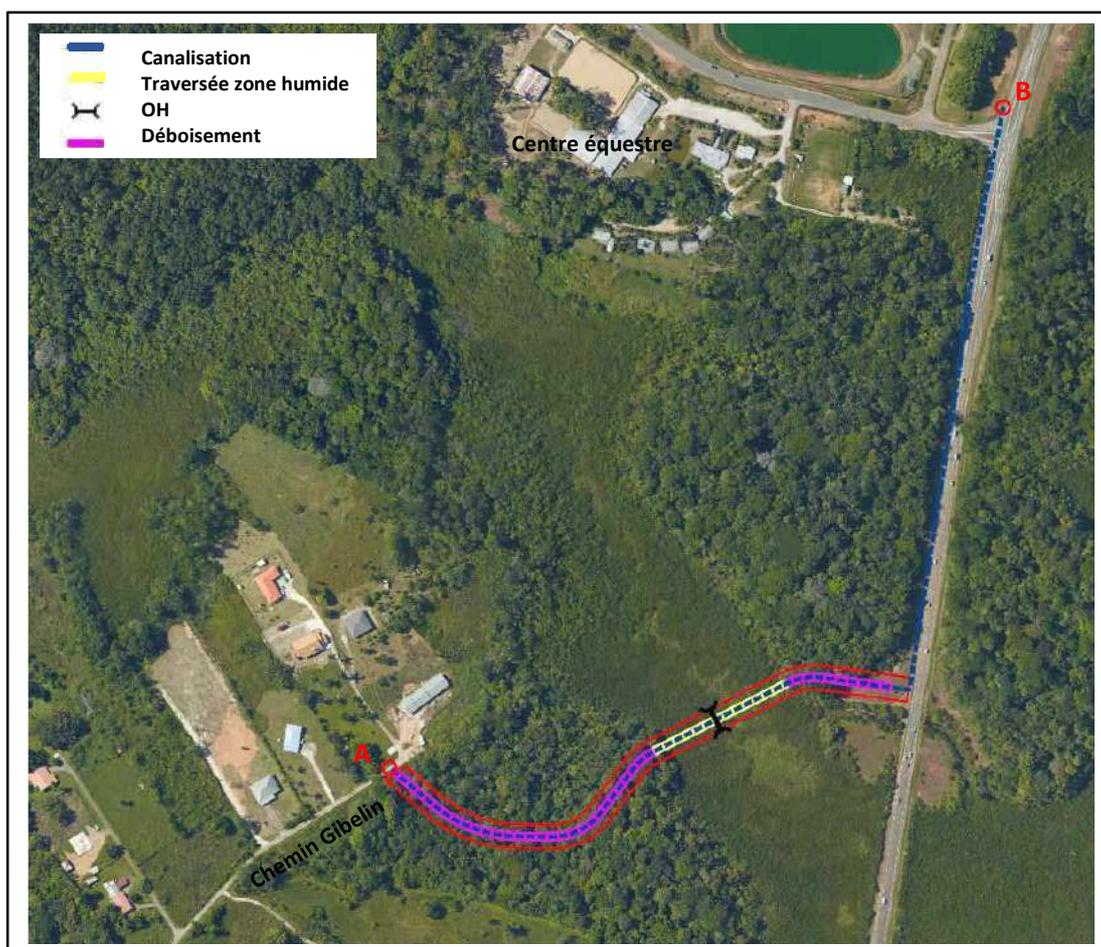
Variante n°3 sur le tracé de la conduite d'adduction
